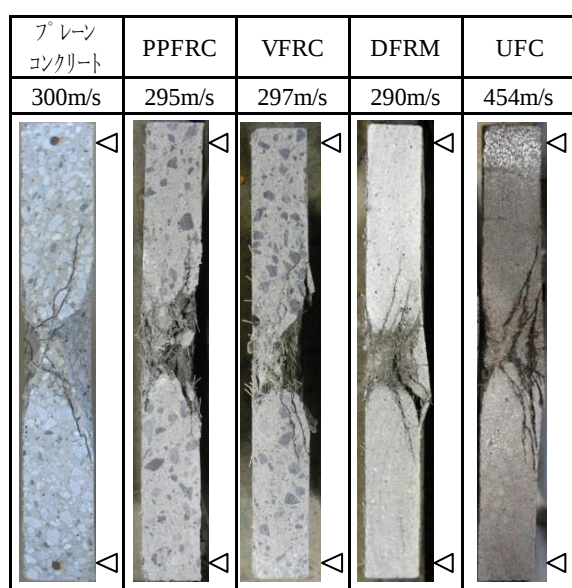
プレーンコンクリート板、繊維補強コンクリート板および UFC 板の破壊断面
